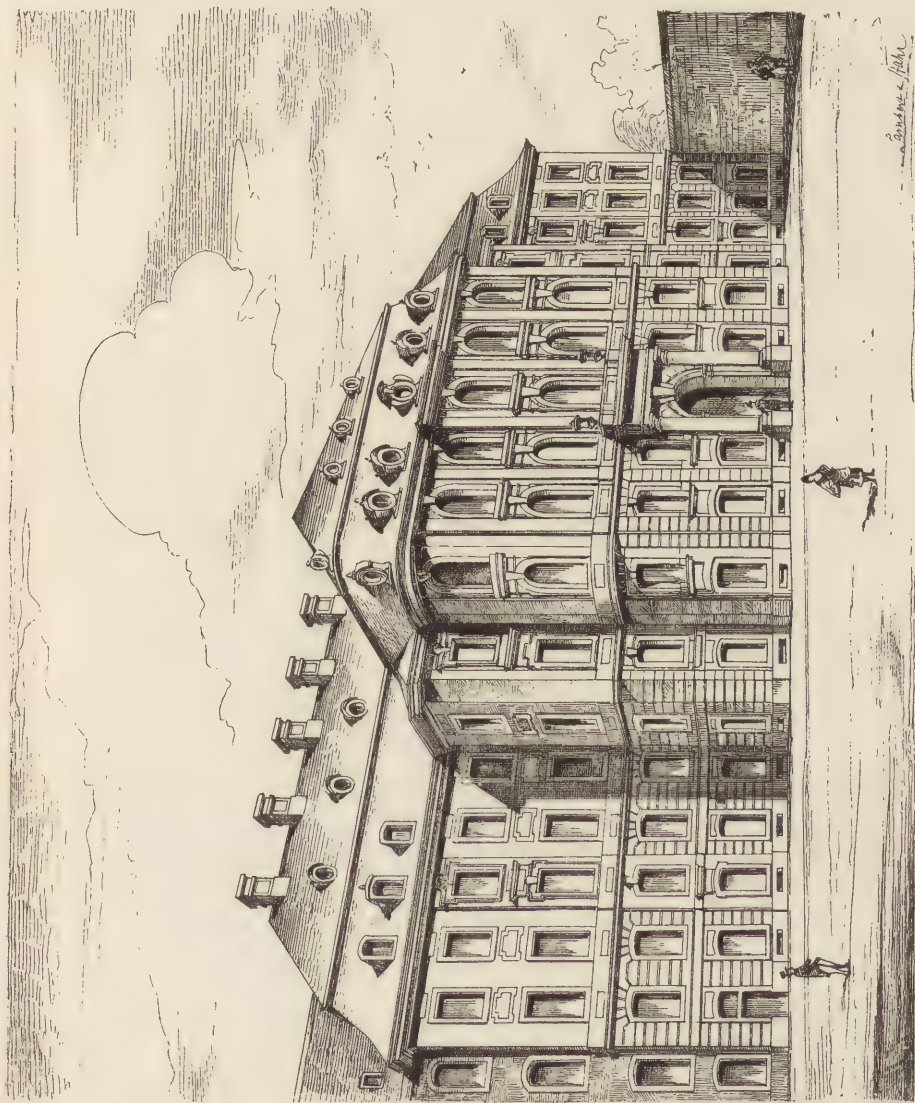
Landhaus zu Dresden. Gartenfaçade.
